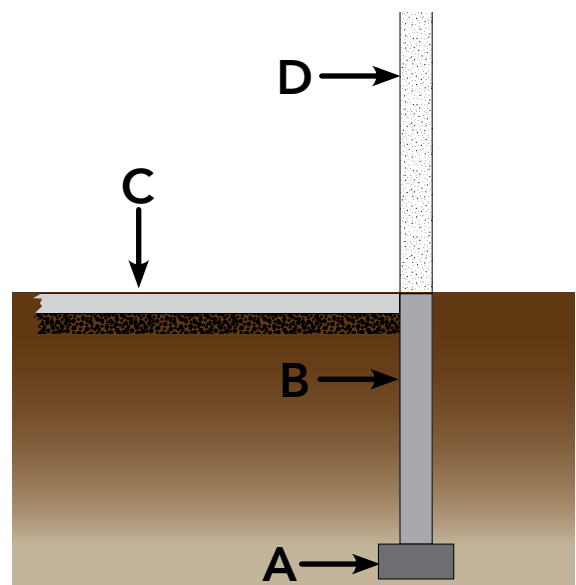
Illustration d'une semelle (A), d'un mur de fondation (B), d'une dalle (C) et d'un mur (D).
